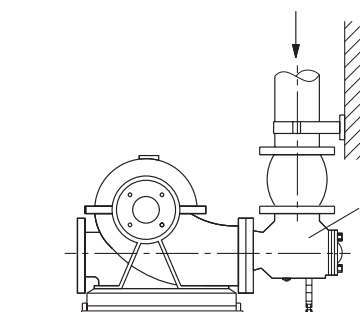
Диффузор (1) во всасывающем трубопроводе
